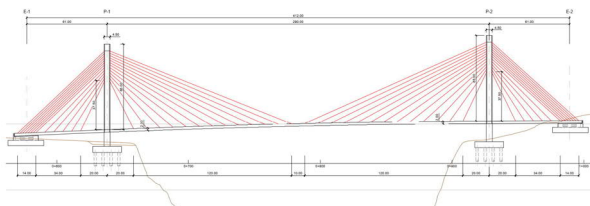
Alzado del puente diseñado. Fuente: TYPESA.
